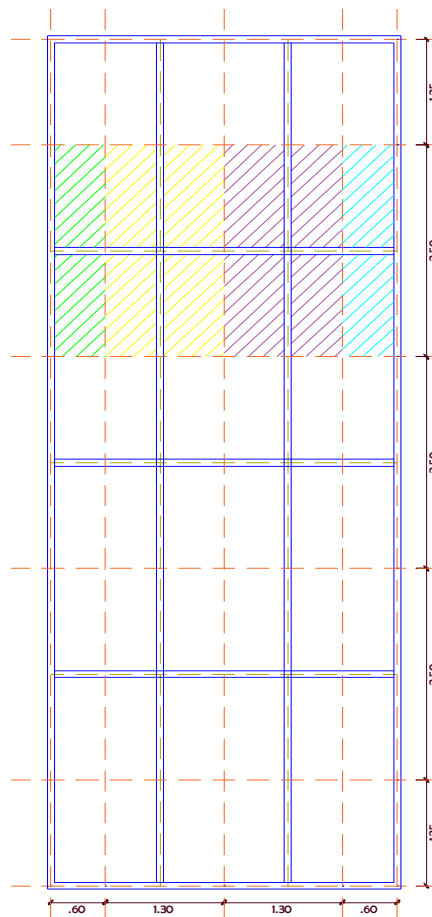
Detalle en planta de la cobertura metálica para el análisis y diseño.
